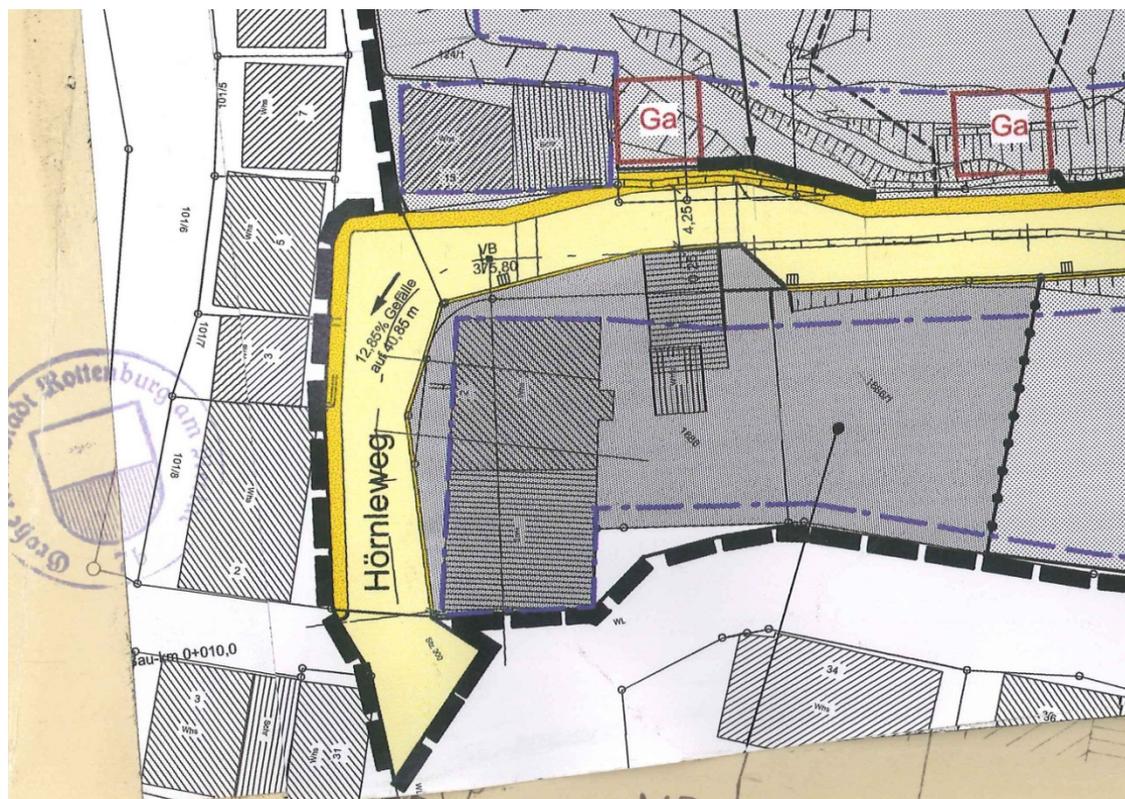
Bebauungsplan „Hörnleweg, 2. Änderung“ vom 09.07.2004, ohne Maßstab, westlicher Bereich
